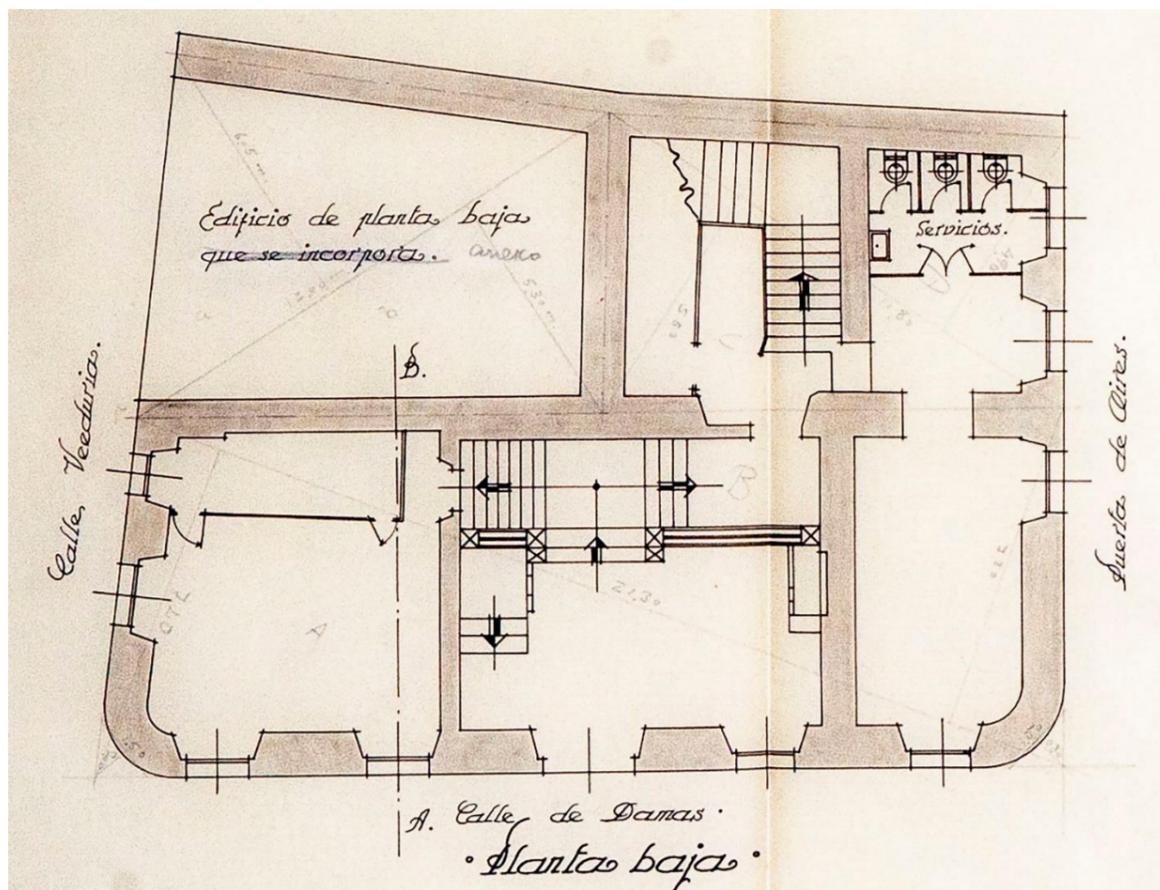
Planta baja de la Casa Cornide. 1951, Peregrín Estellés. AMC. Fondo Tenreiro, caja 26 (1). Foto José Caruncho
